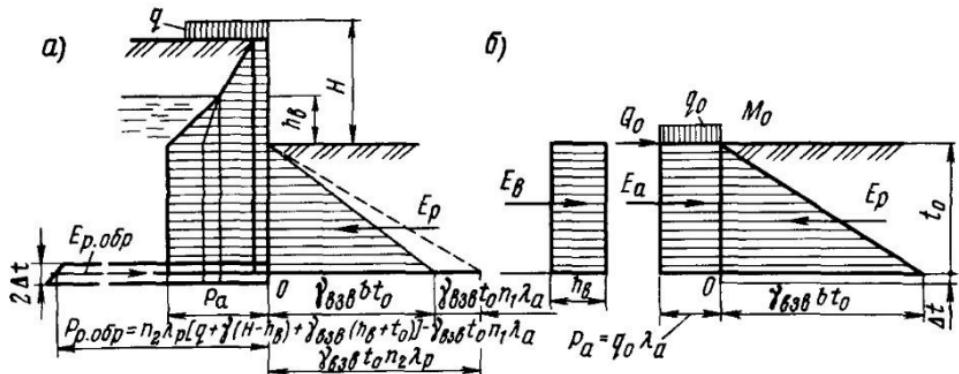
Схема для расчета свободно стоящей стенки в несвязанных грунтах:
